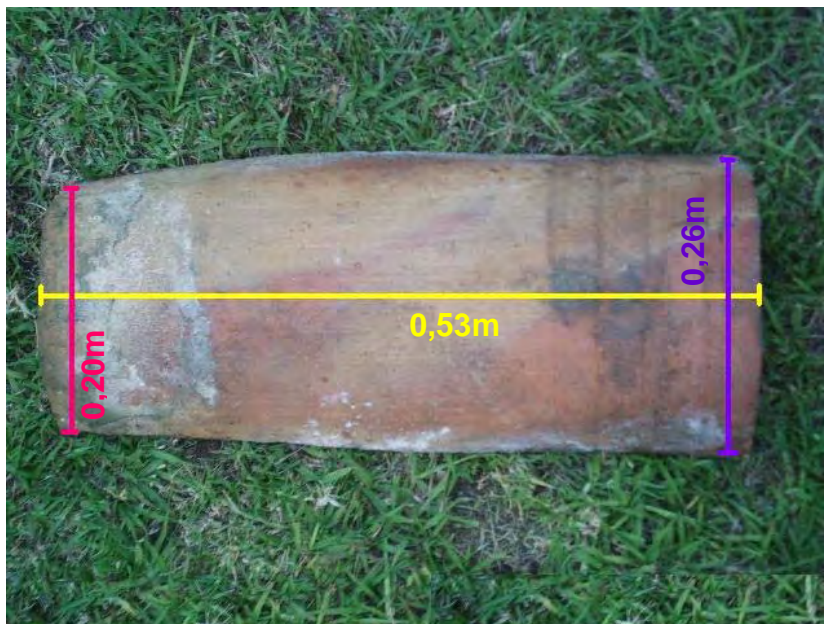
Telha empregada nas construções da estância Vista Alegre.
